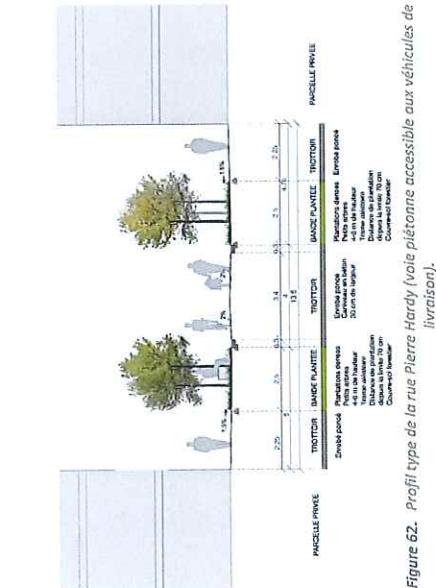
Profil type de la rue Pierre Hardy (voie piétonne accessible aux véhicules de livraison).
